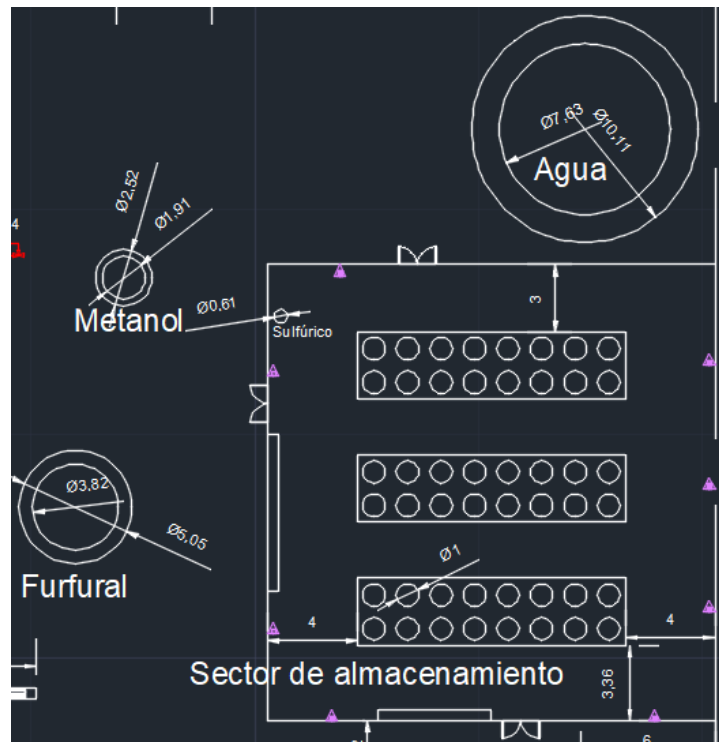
Dimensiones de tanques y toneles de almacenamiento en el plano de la planta.
